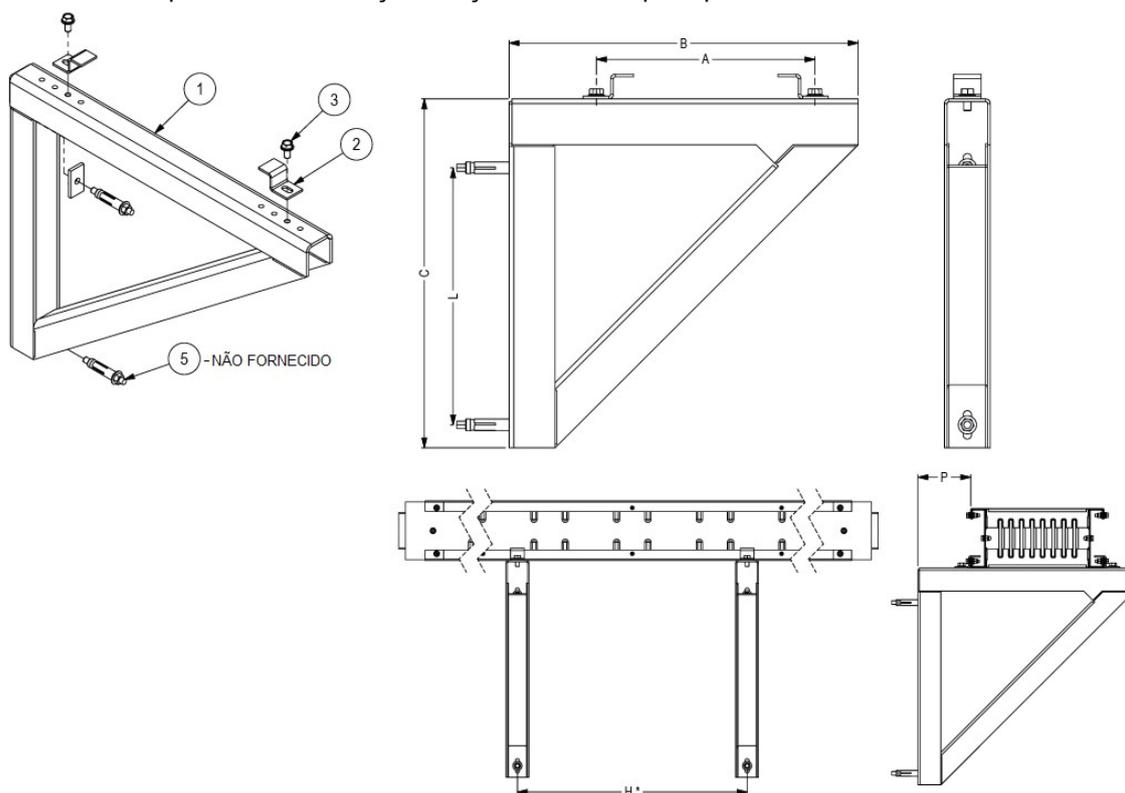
Suporte de sustentação/fixação horizontal para parede.
